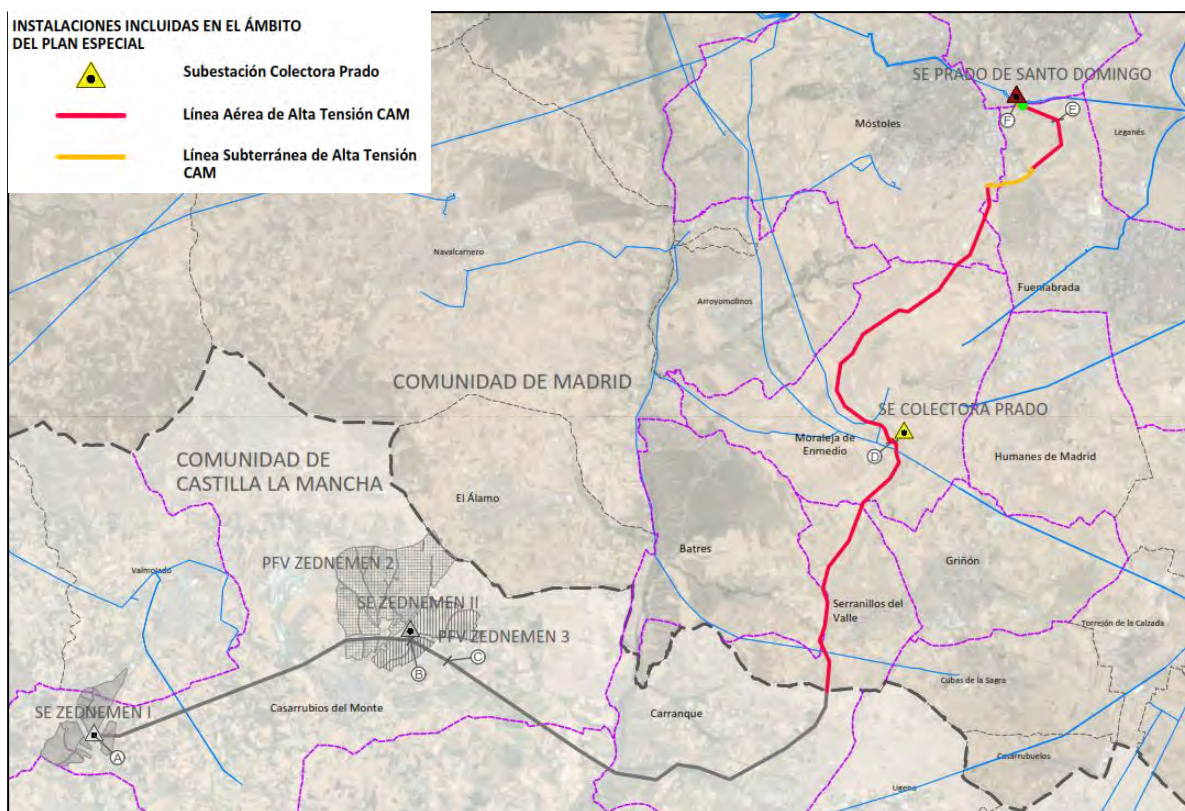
Plano del trazado del proyecto presentado en el Borrador del Plan Especial
